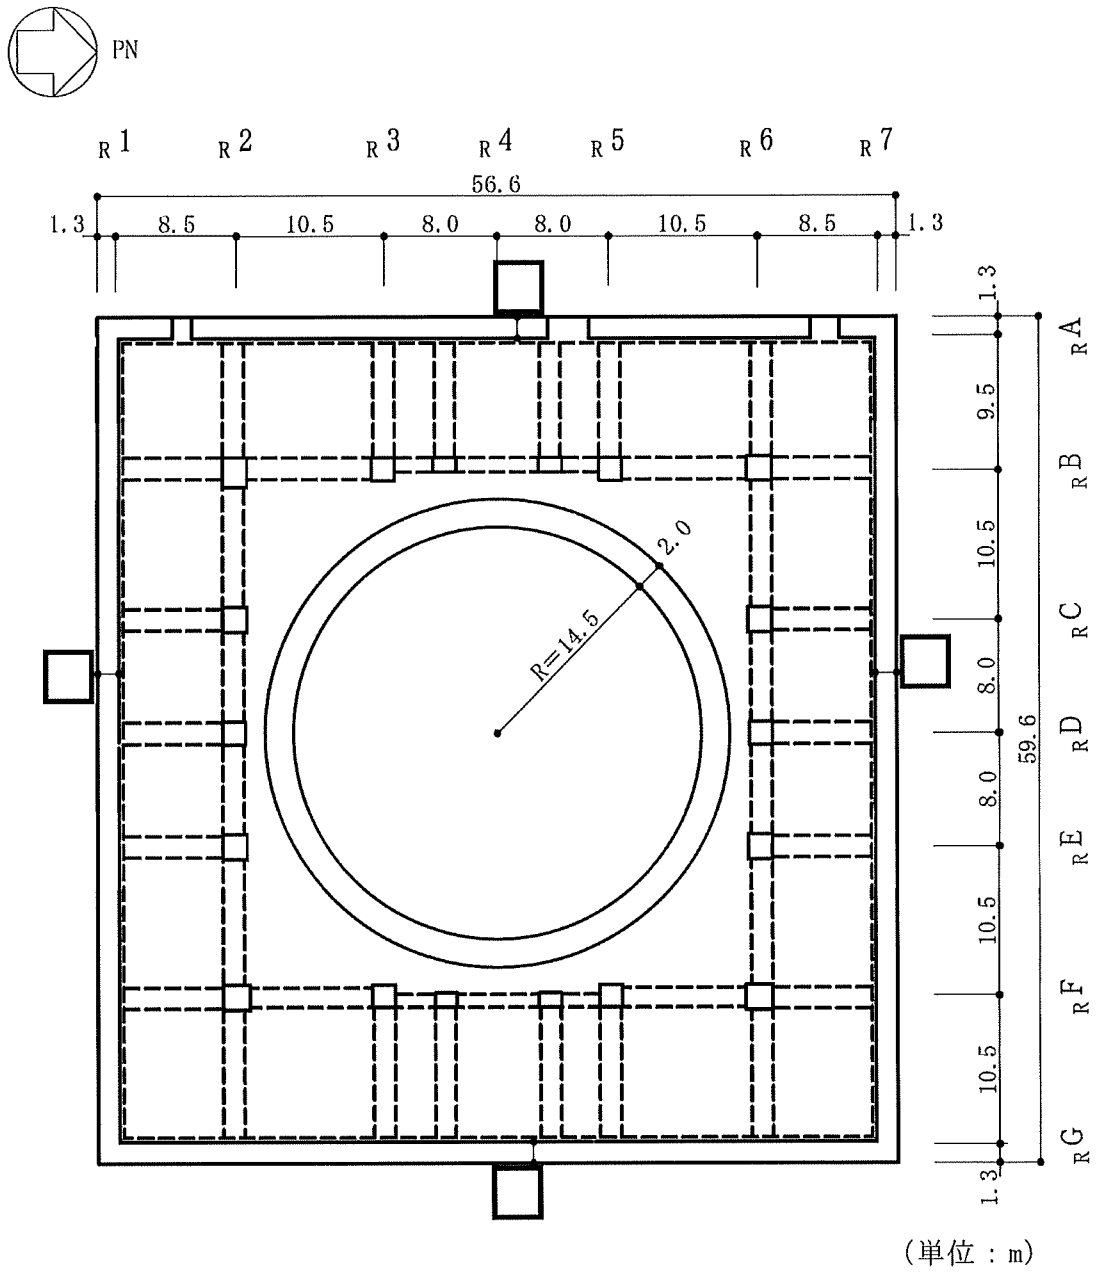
原子炉建屋の概略平面図 (B1F, T.M.S.L. 4.8m) (3/9)
